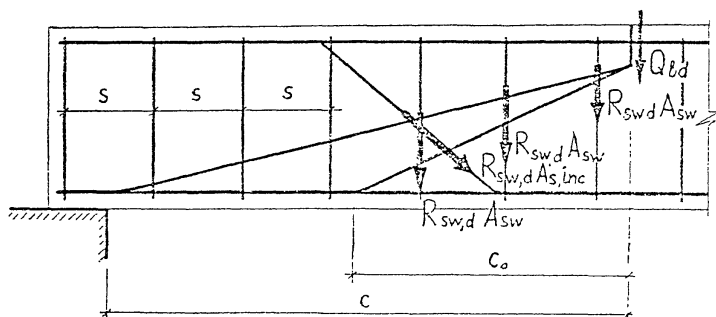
Схема усилий в сечении, наклонном к продольной оси железобетонного элемента, при расчете его по прочности на действие поперечной силы
